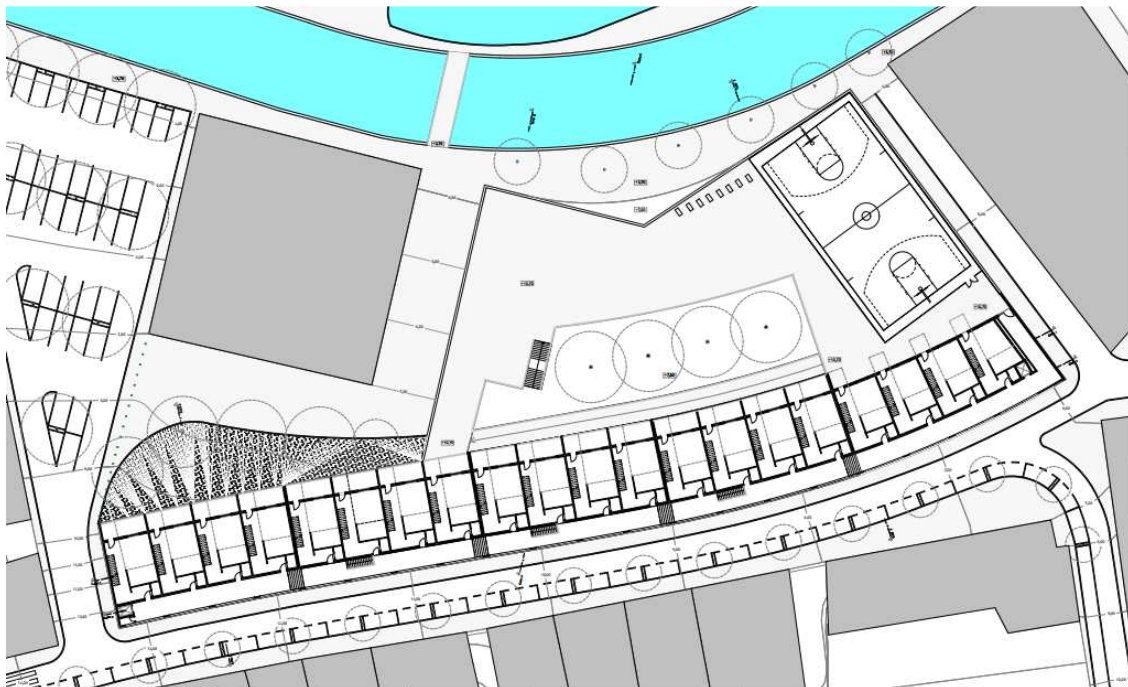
Painel final n.º5 - Habitação colectiva para jovens – Planta do 1º andar
